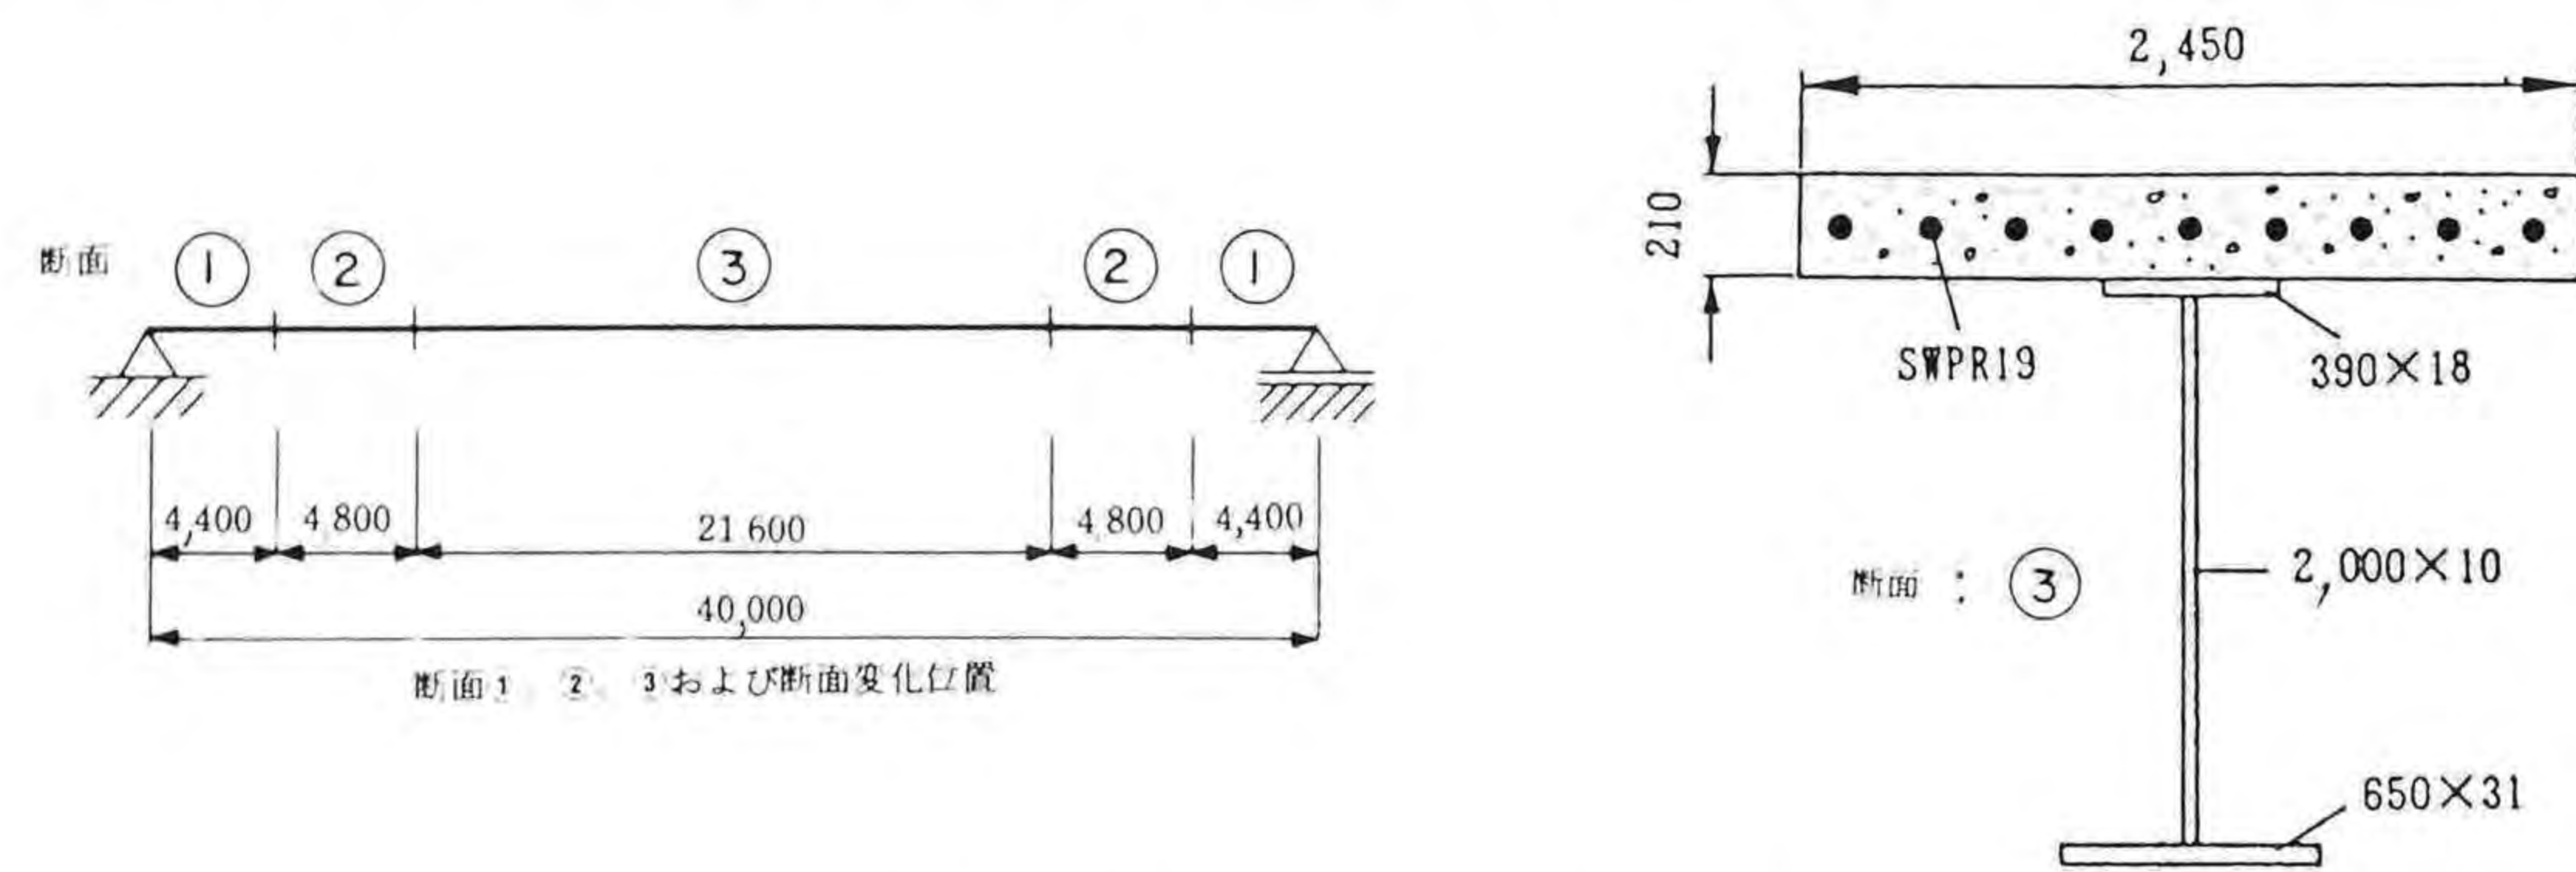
合成桁の断面形状・寸法 (単位: mm)
